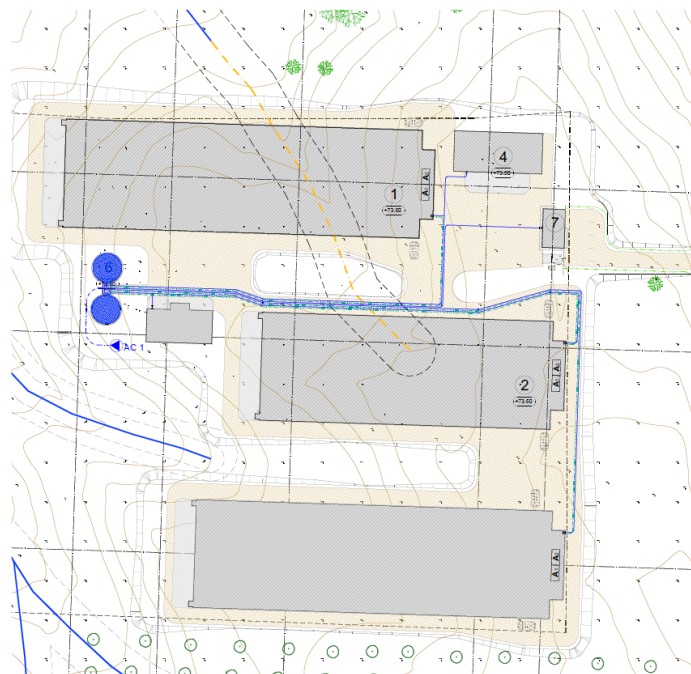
Enquadramento dos reservatórios de água e da captação a construir (AC1) na planta de implantação
